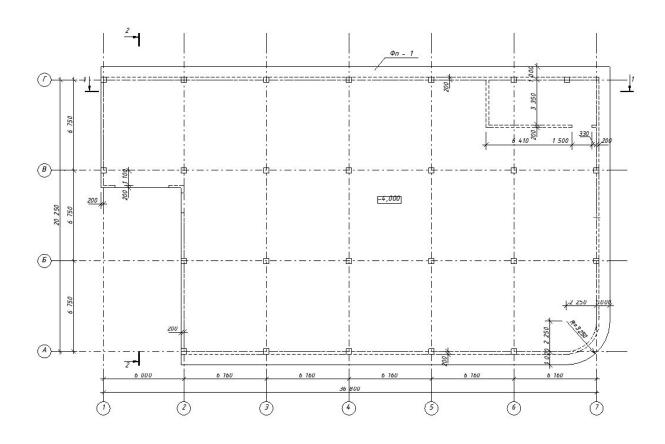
Схема монолитной железобетонной фундаментной плиты
